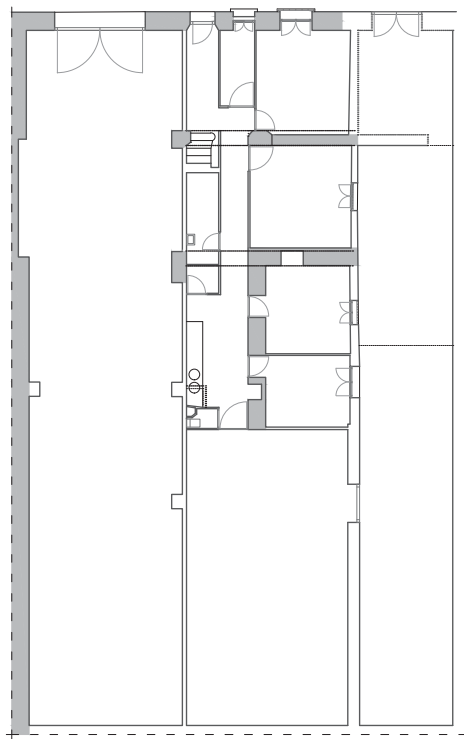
Plano de planta baja según estado actual. Sombreado de elementos anteriores a 1805 (Fuente: elaboración propia. Sombreados a partir del plano de Josef Delgado)
